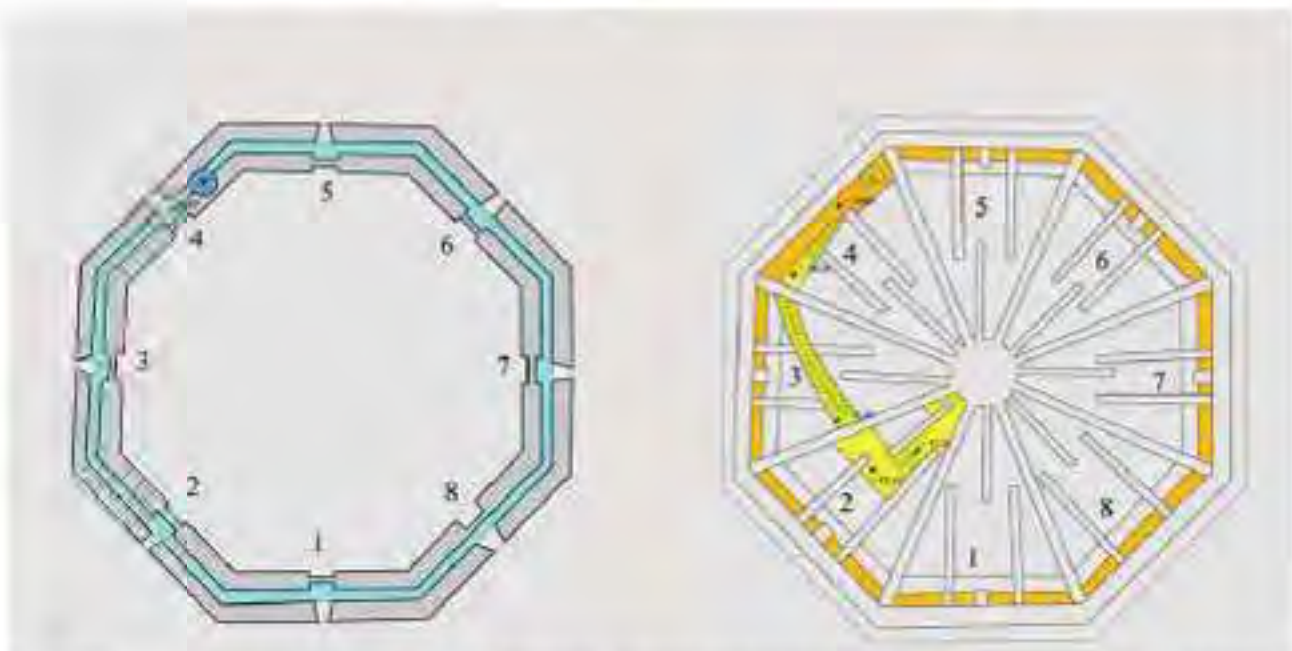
Assetto ipotetico dei collegamenti verticali. A sinistra, lo schema planimetrico del tamburo e a destra, lo schema planimetrico della cupola
